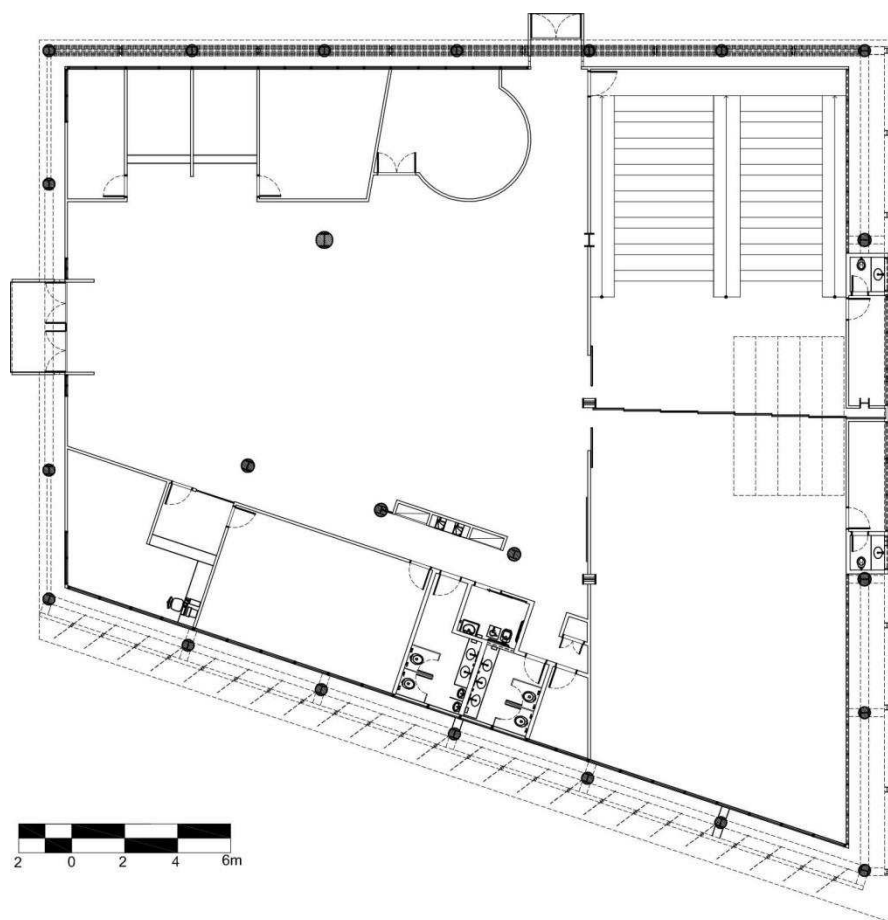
Planta do pavimento térreo do Edifício das Licenciaturas.
